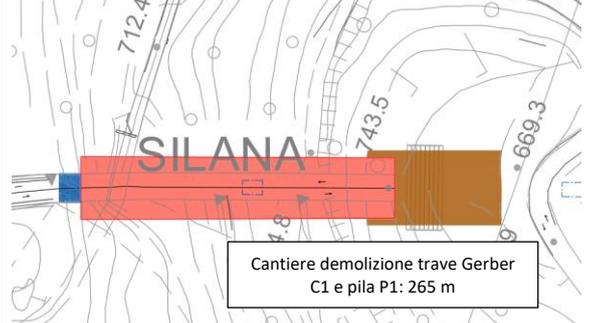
Estratto elaborato V382021002APA "Planimetria aree di cantiere e viabilità di servizio"
